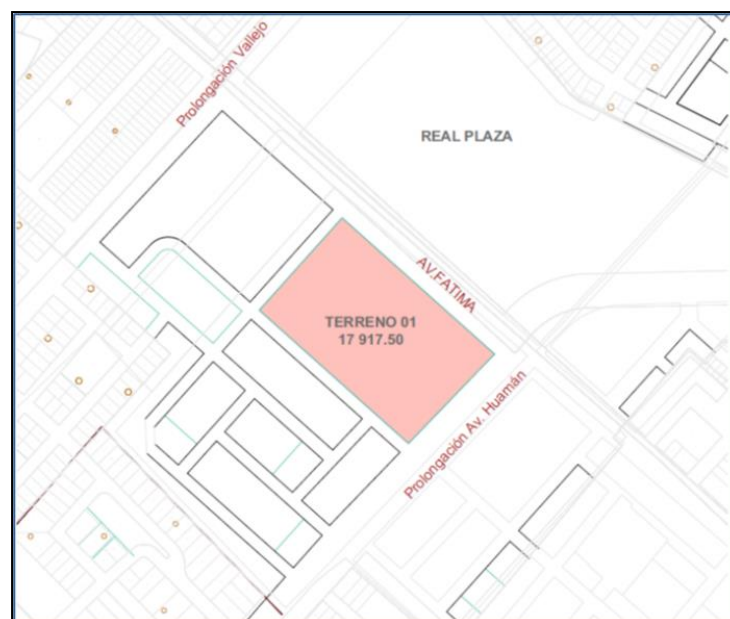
Plano Terreno 01 Fuente: Elaboración Propia
